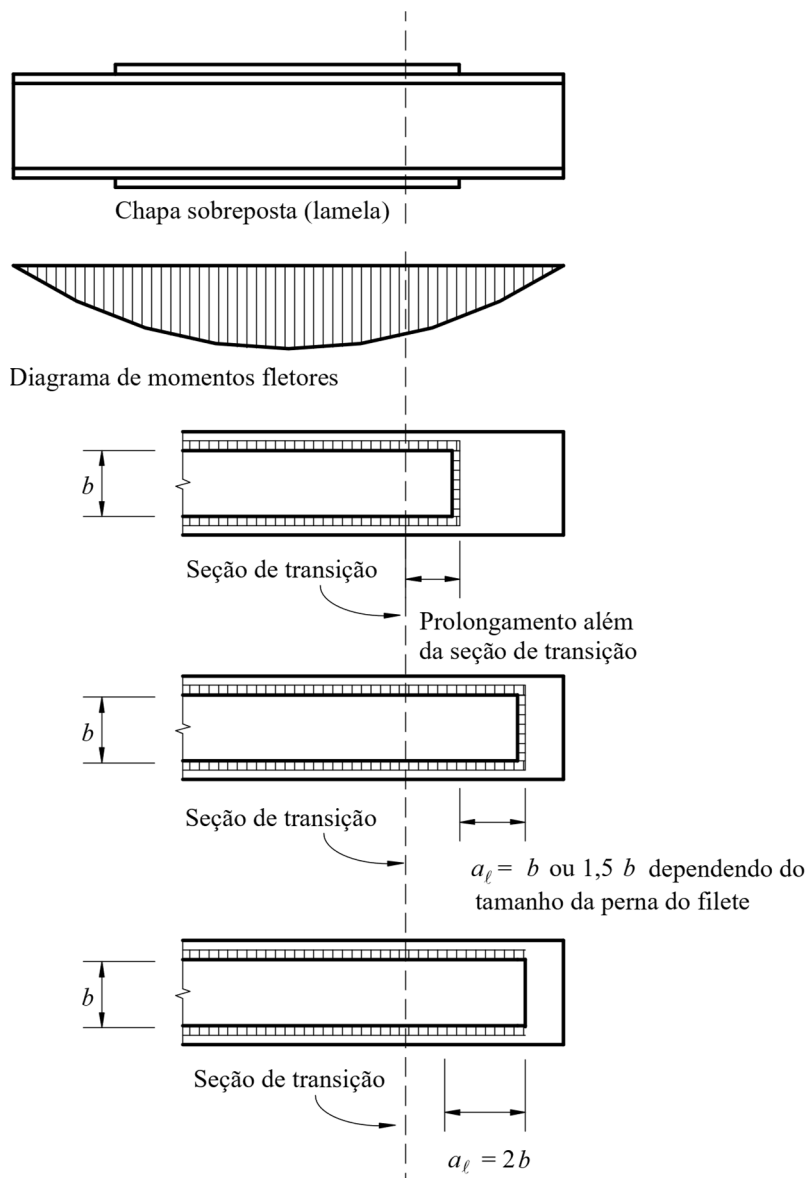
Chapas de reforço sobrepostas a mesas de vigas
